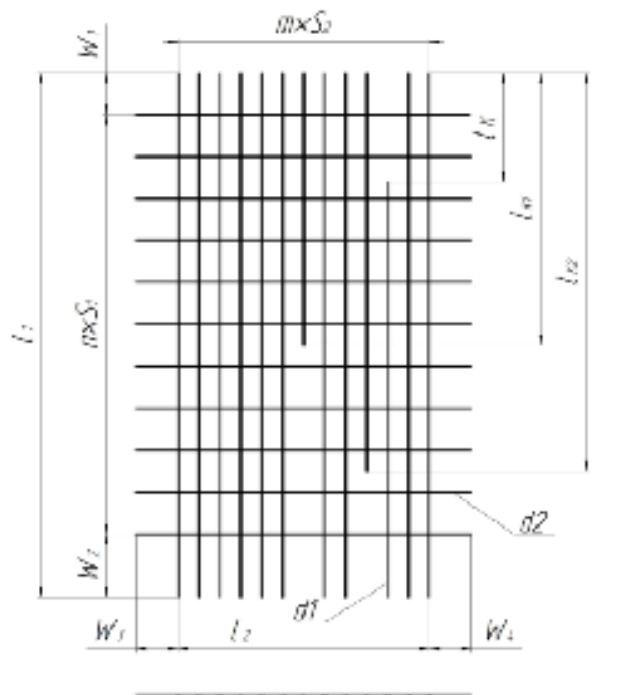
Пример вида и обозначений геометрических параметров нестандартного сварного каркаса
